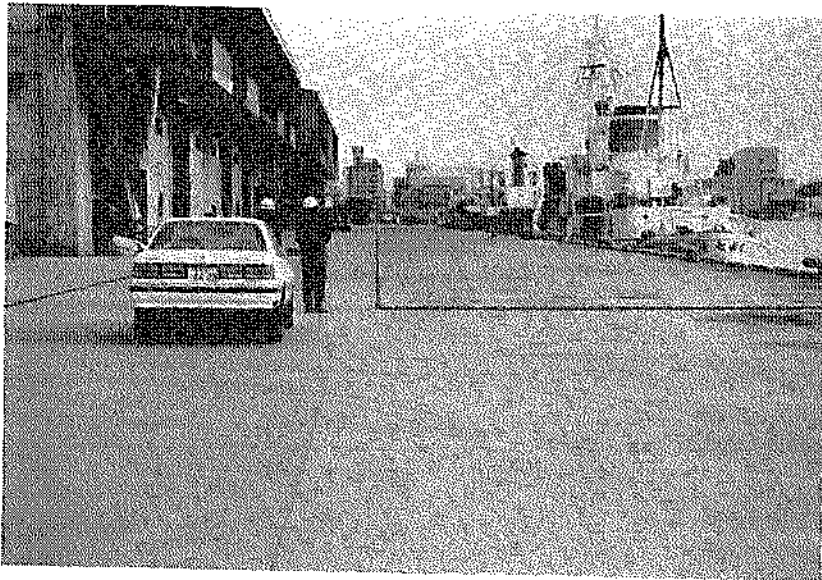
中央埠頭地区, ㊦第5バース(-7.5m)
